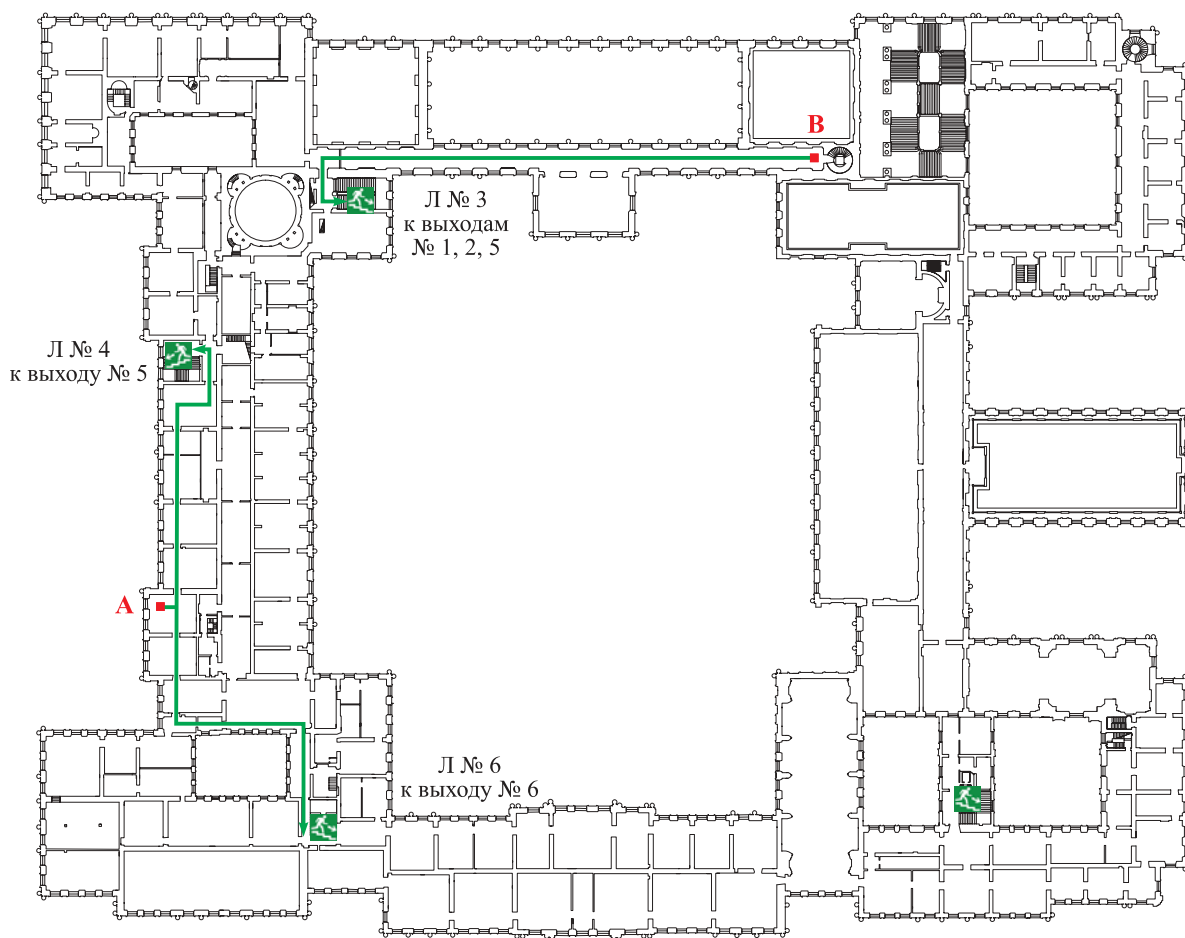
План 3-го этажа Зимнего дворца Государственного Эрмитажа
